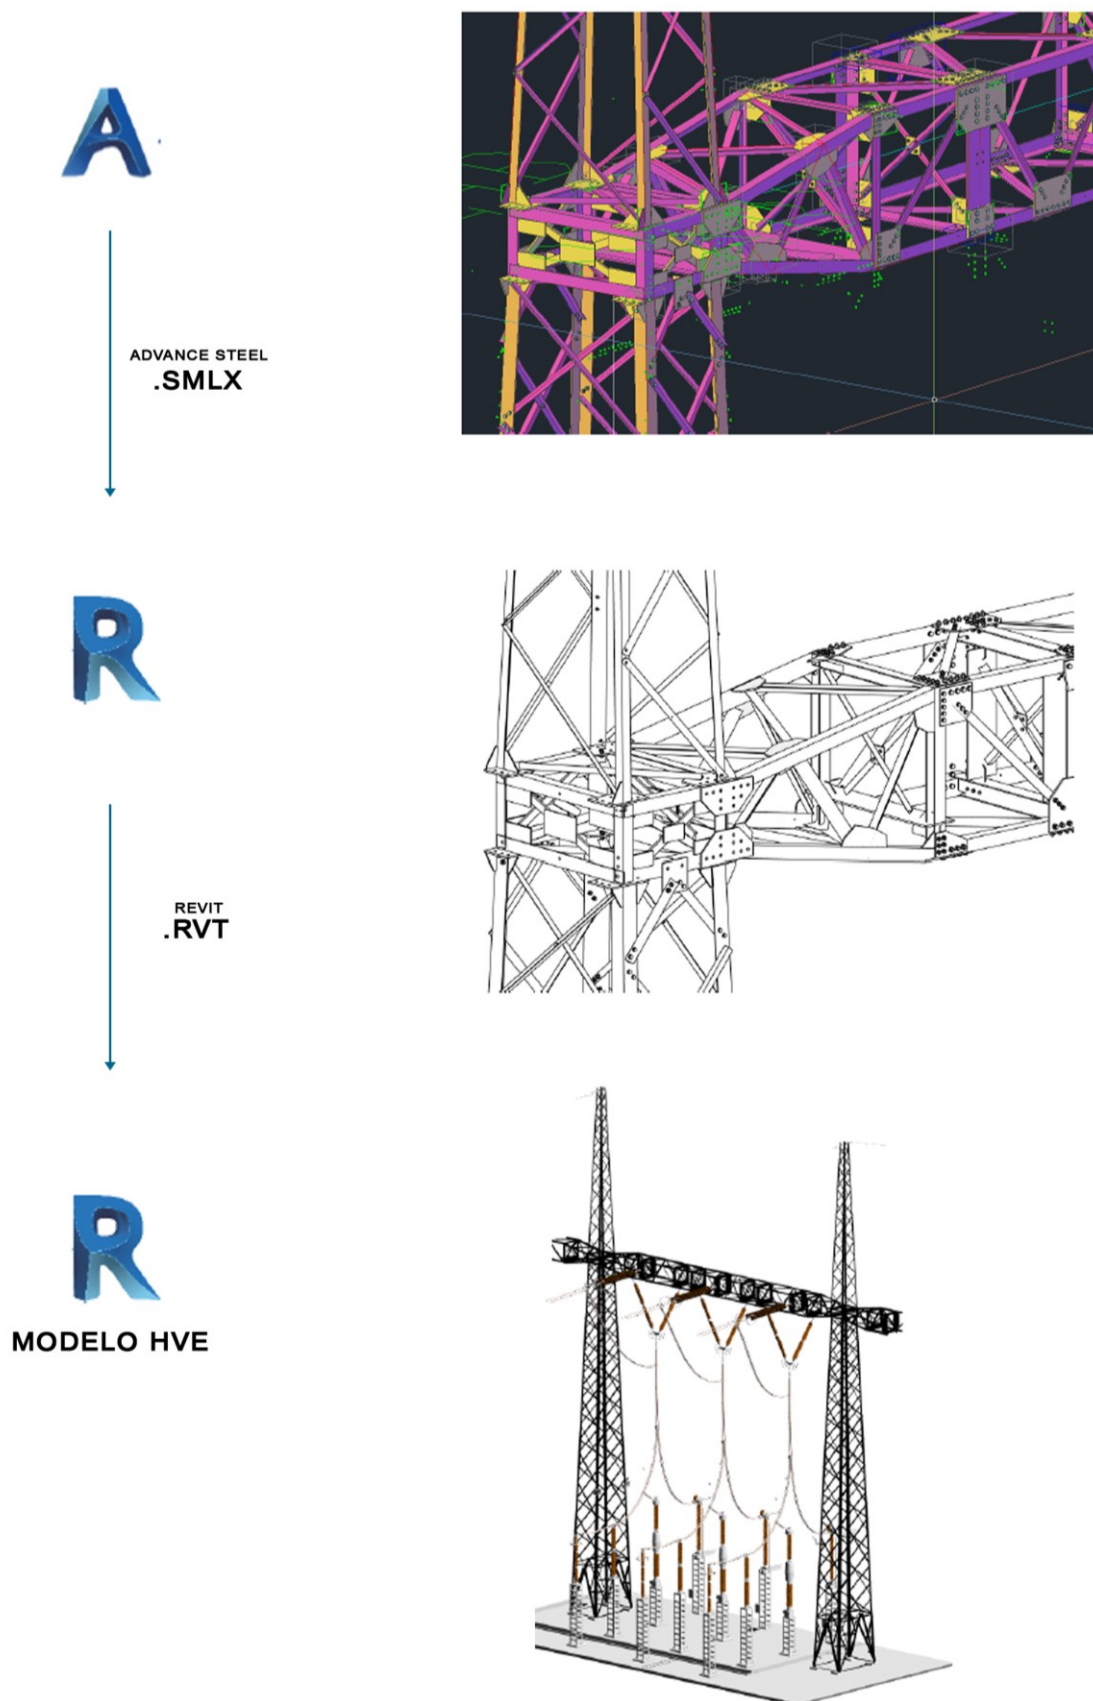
Integração Revit com Advance Steel – Projetos de Subestações.
